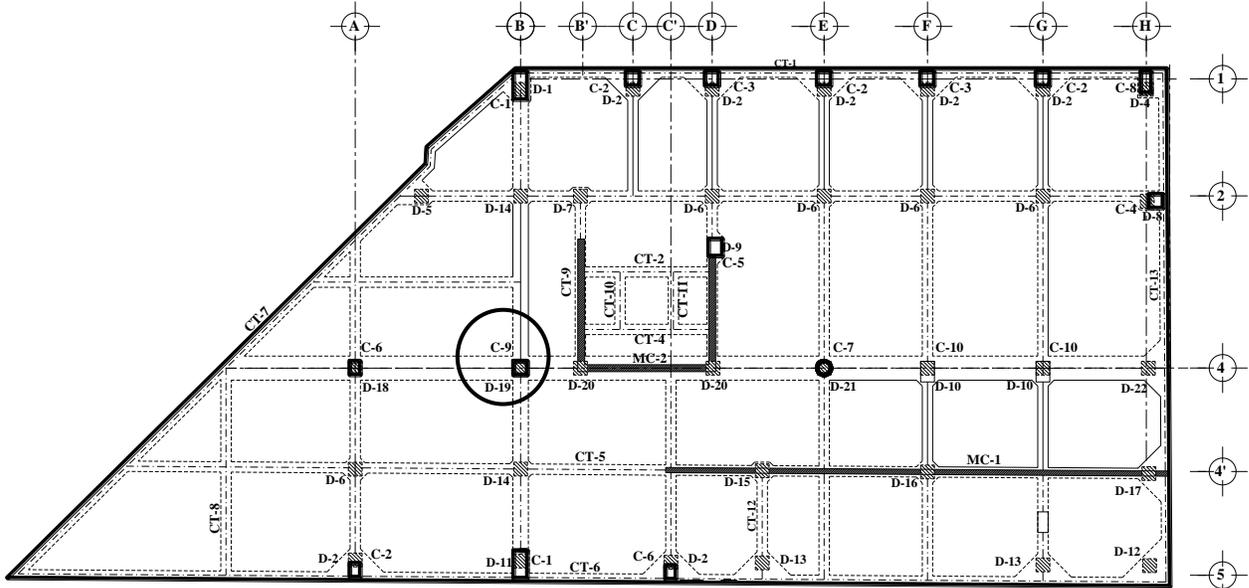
Vista en planta del primer nivel (Niv. -1.45-Niv.+1.62)
